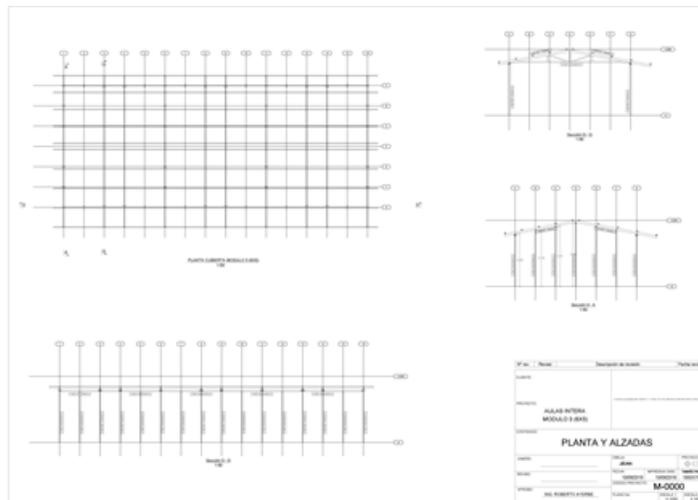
Planos Sistema constructivo, Elaborado Por la Empresa Meisa Sas. Fuente: Intera Sas
